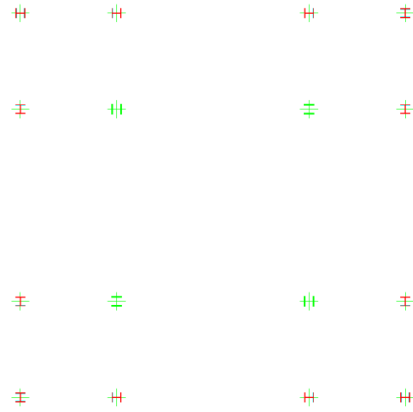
b Disposición de columnas en planta [elaboración propia]
